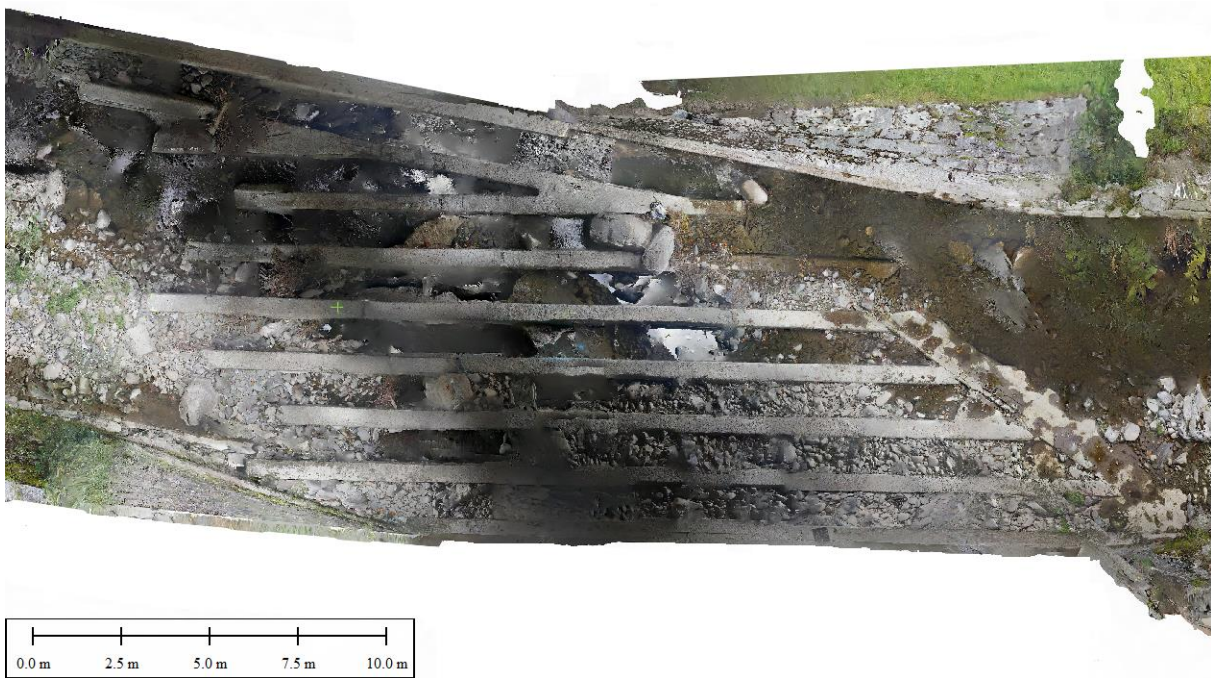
Longrines béton dans le lit au droit du Pont Neuf
